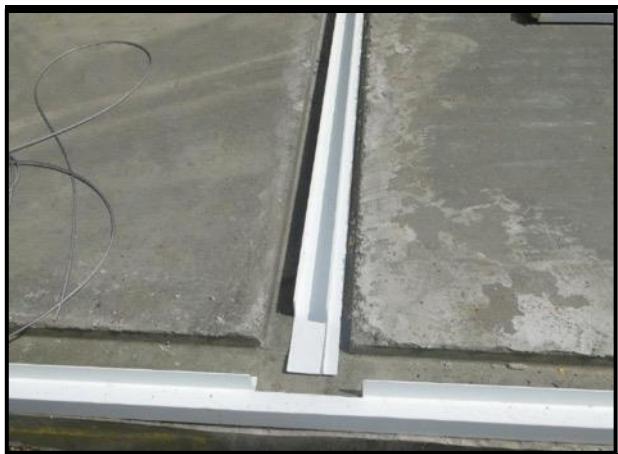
Perfil em PVC para fixação parede com a fundação.
